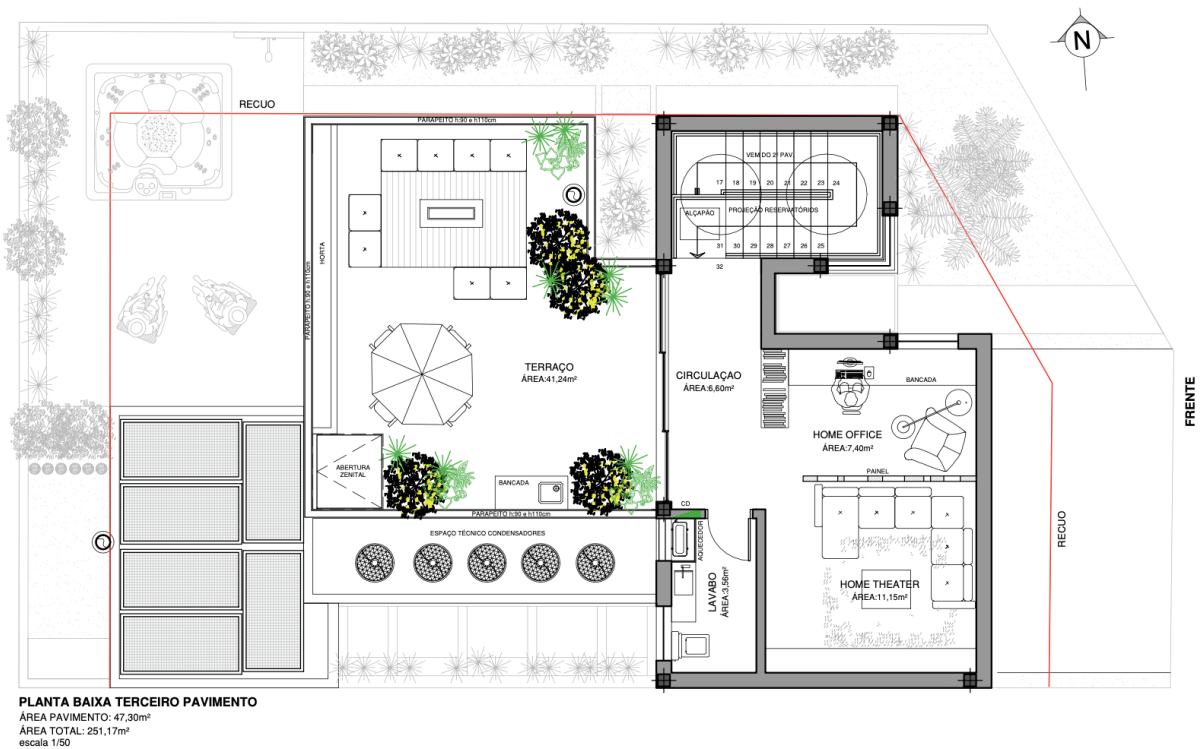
Planta baixa terceiro pavimento. (Fonte: Projeto Arquitetônico)
